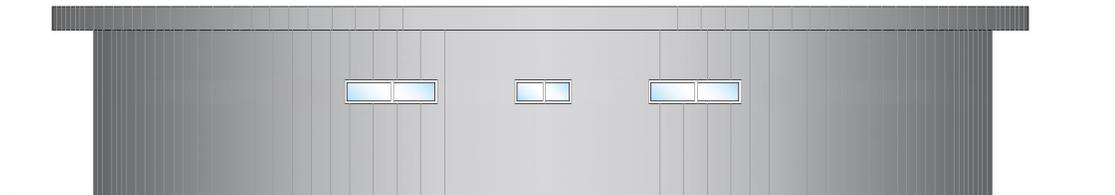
Fachada Posterior - Baterías Sanitarias
